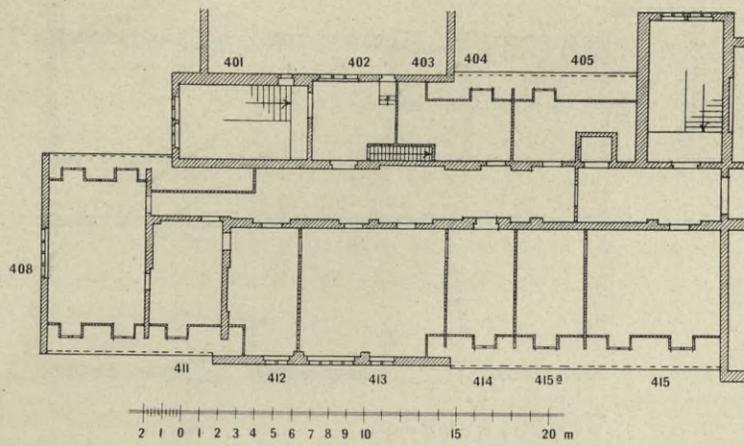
Organ.-chem. Institut. Dachgeschoß.
